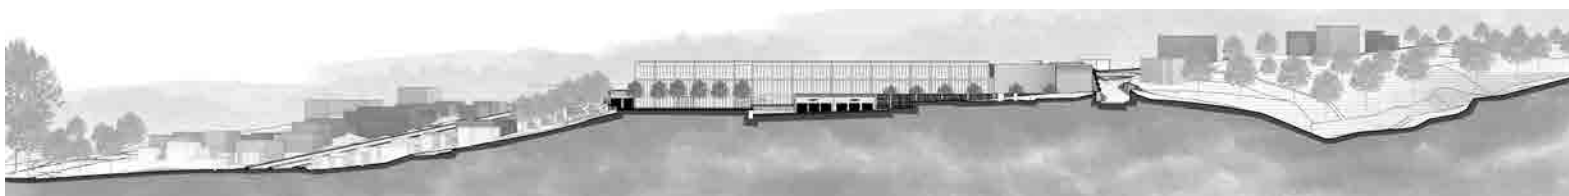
Sección lateral derecha. Elaboración: Autores.
